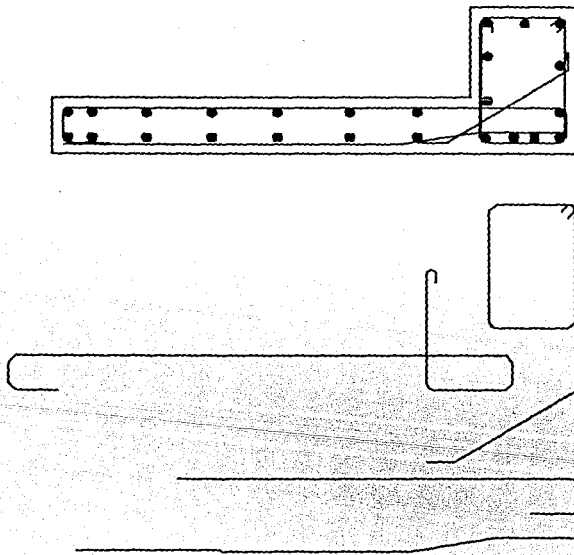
Viga que soporta una losa en voladizo. (1.1)
